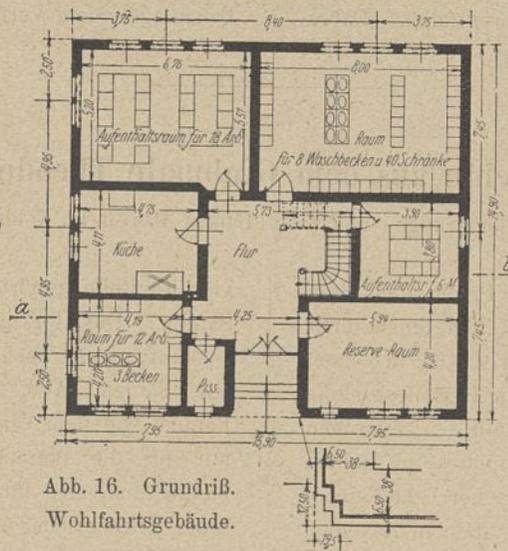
Grundriß. Wohlfahrtsgebäude.
